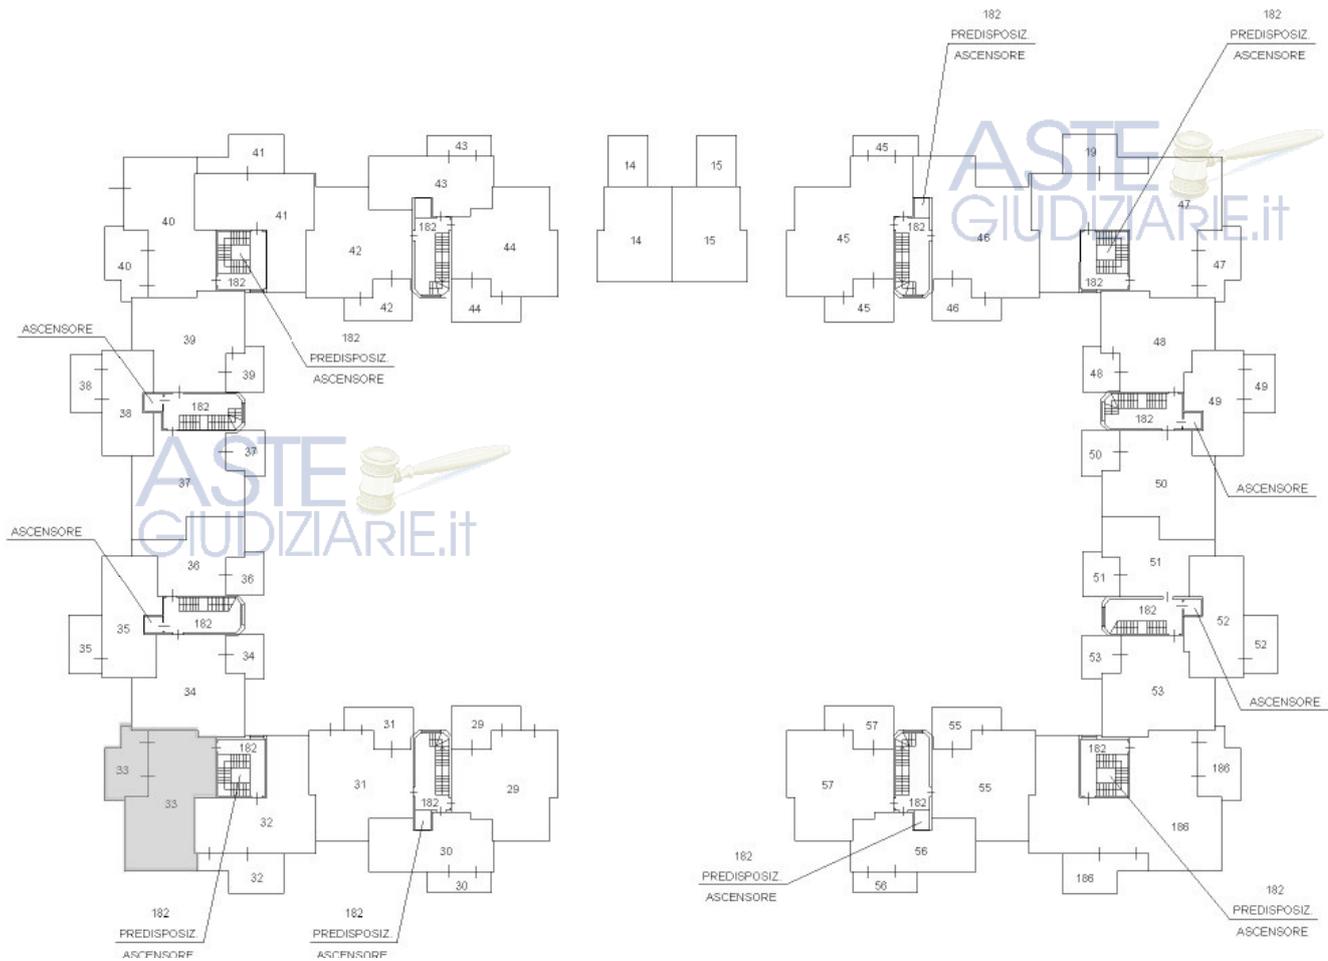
Piano primo - Individuazione immobili su planimetrie catastali
